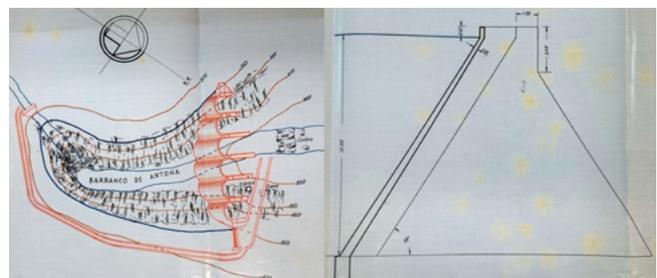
Planta y perfil tipo de Antona (1949). Fuente: Servicio Hidráulico de Las Palmas de Gran Canaria.
